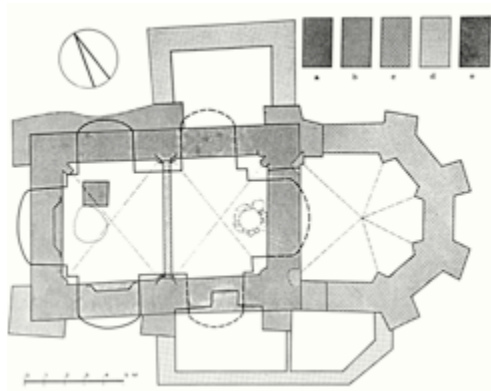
Grundriss der Maria-Magdalena-Kapelle und der „Virgilkapelle“ auf dem Stephansplatz in Wien, mit Baualtersangaben
